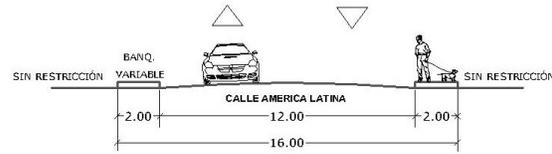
Sección Vial Calle América Latina. PDU 2040 Sexta Actualización.
